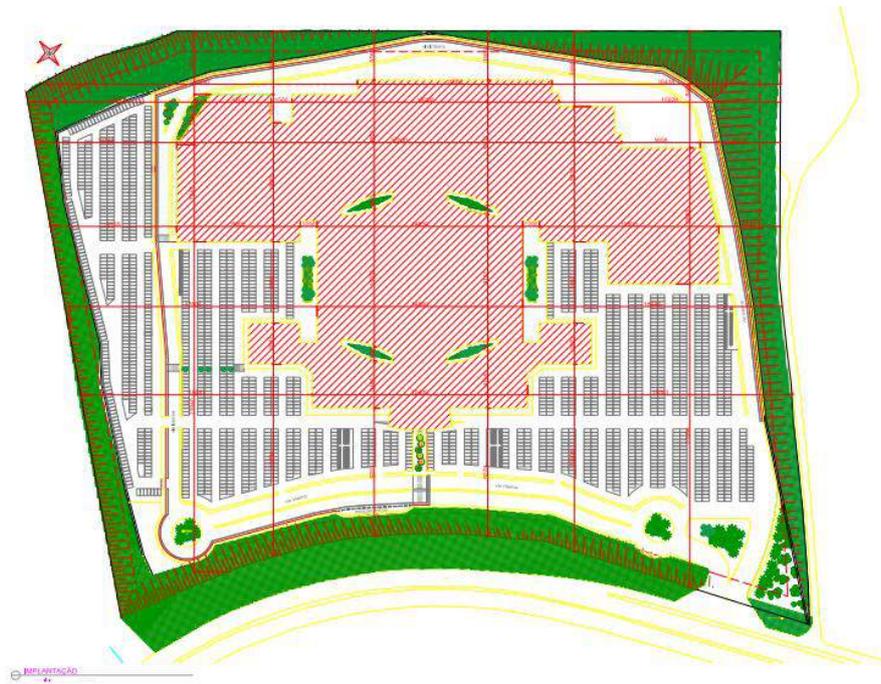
Proposta de projeto arquitetônico de implantação do empreendimento (adaptação – Fonte: Empreendedor) .
